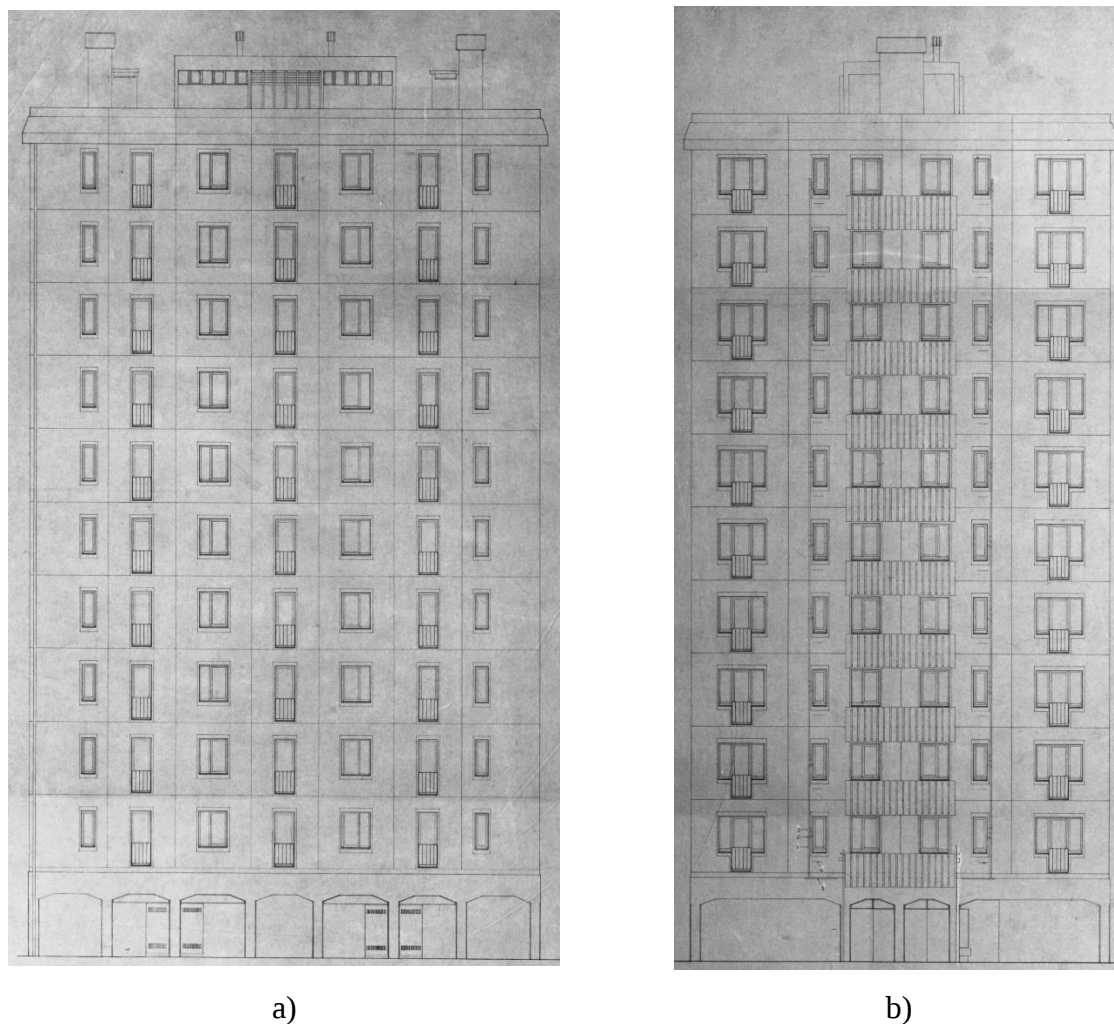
Alçado principal: a) plano XZ; b) plano YZ (ICESA, 1974).
